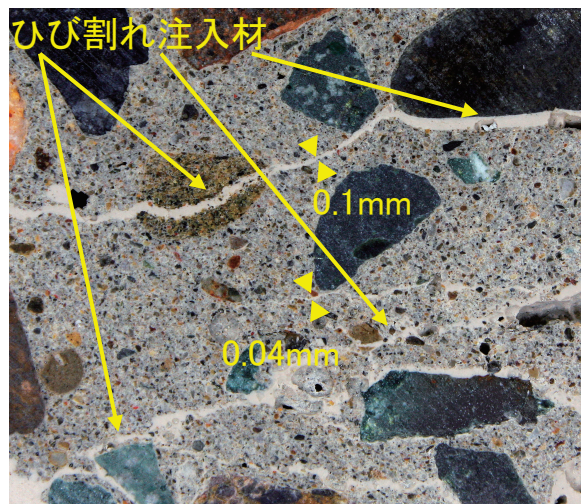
新開発ひび割れ注入材のひび割れ注入状況
